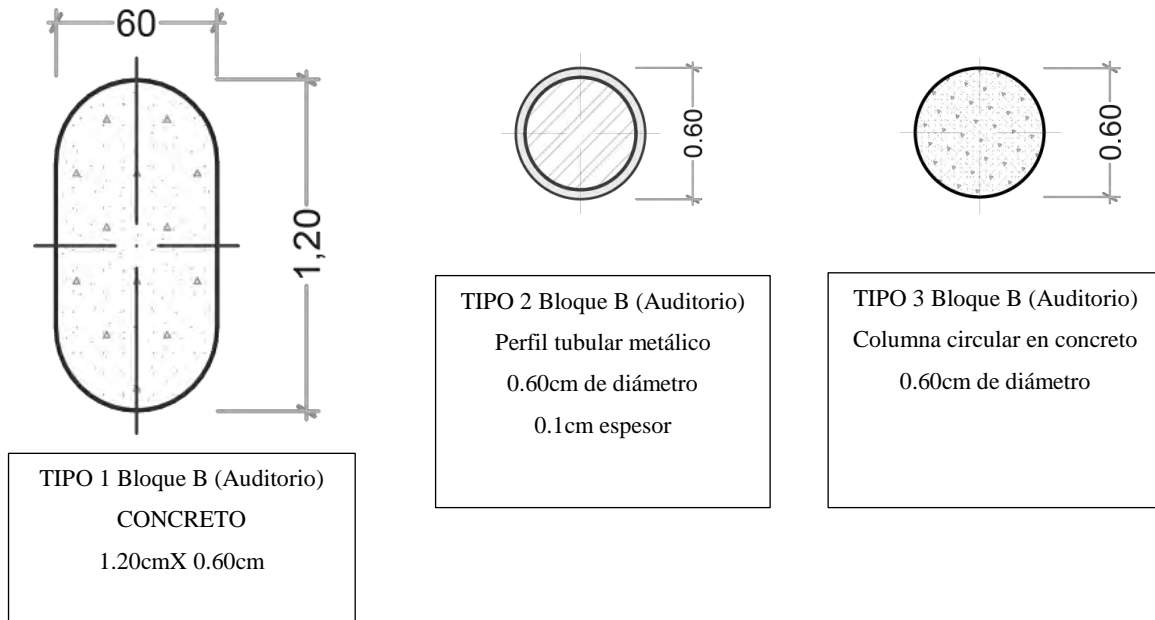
Propuesta estructural. Detalle de conexión columna de concreto y perfil tubular. Fuente: Elaboración Propia.
